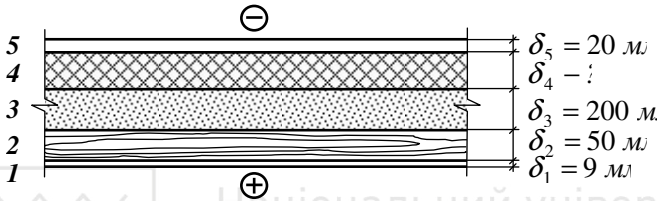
Розрахункова схема конструкції горіщного перекриття (переріз 2-2)
